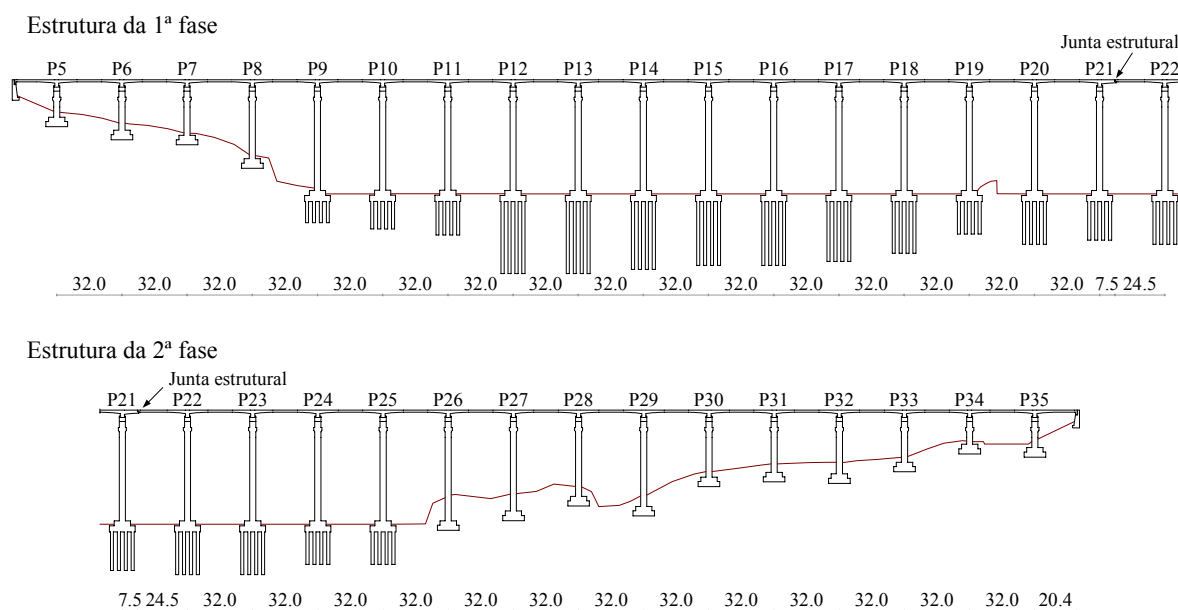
Cortes longitudinais da estrutura de ampliação do aeroporto da ilha da Madeira.
